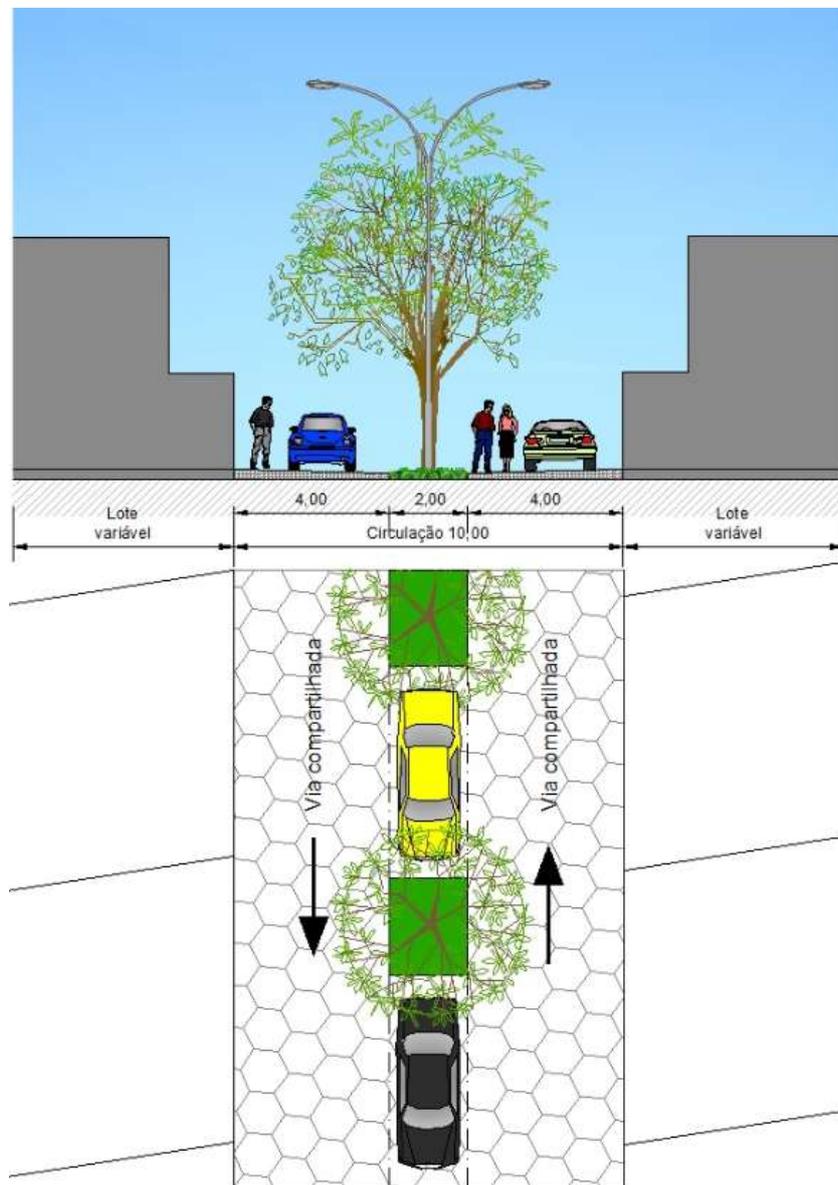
Perfil das vias compartilhadas – Rua Vicentina 1 e 2 (Perfil 03 no croqui)
